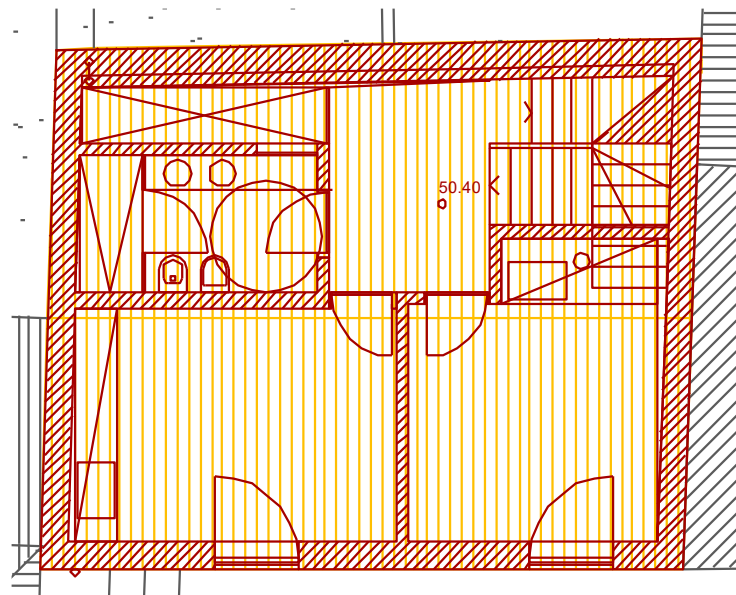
Planta de arquitetura de vermelhos e amarelos do Piso 1
